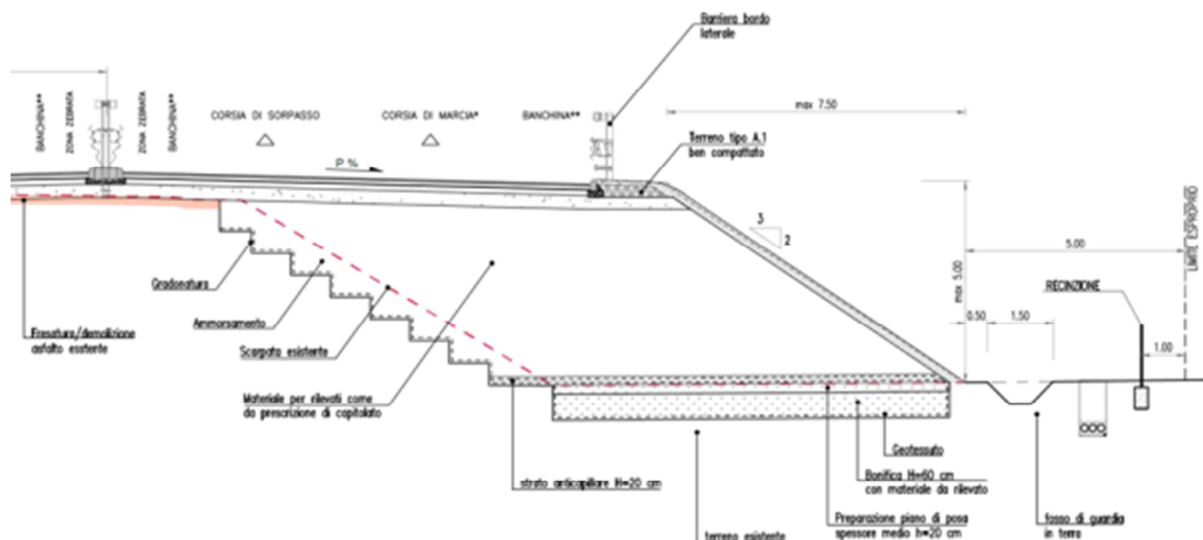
Sezione Tipo in Asse Principale in rettilineo con allargamento da un lato
